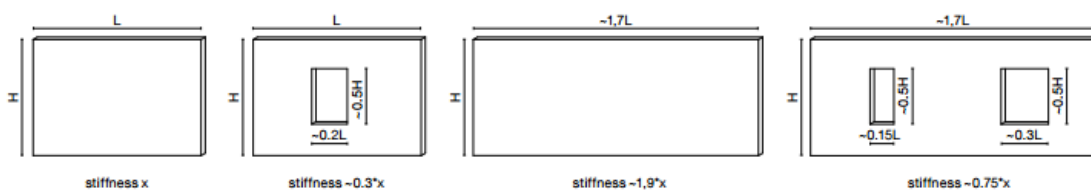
Comparação da rigidez de paredes estruturais CLT com e sem aberturas. (Stora Enso – Residential Multistorey Buildings - Design Manual, 2016).
